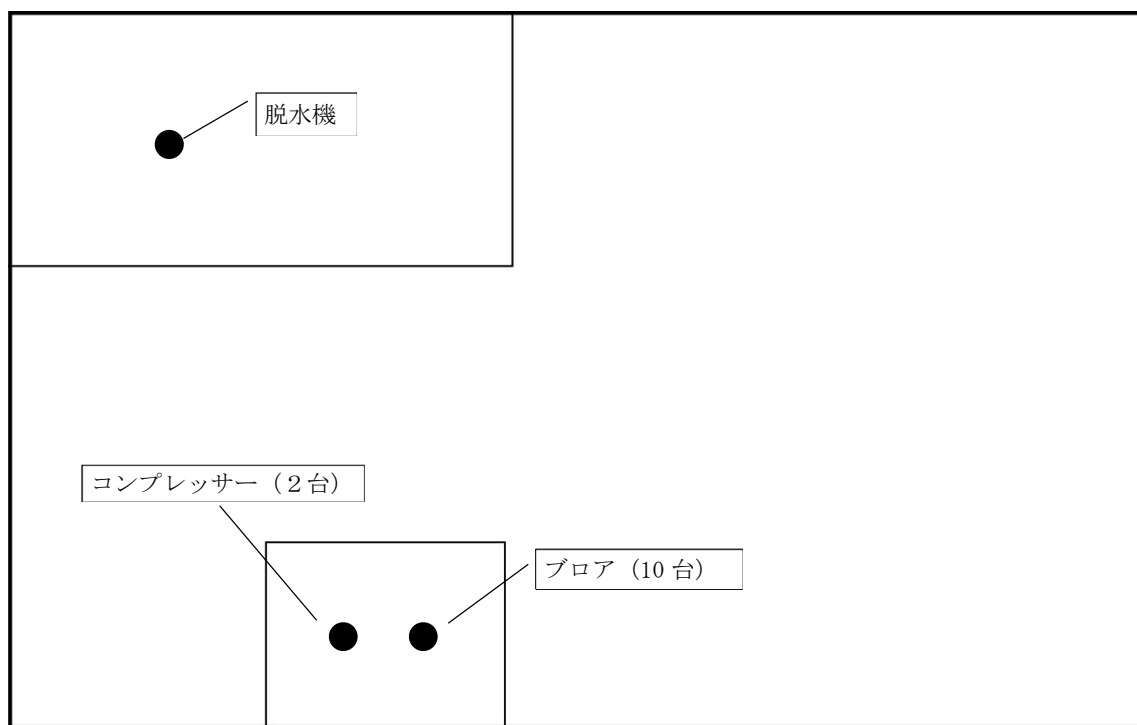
浸出水処理施設の振動源の配置図 [縮尺 1 : 2,000]
